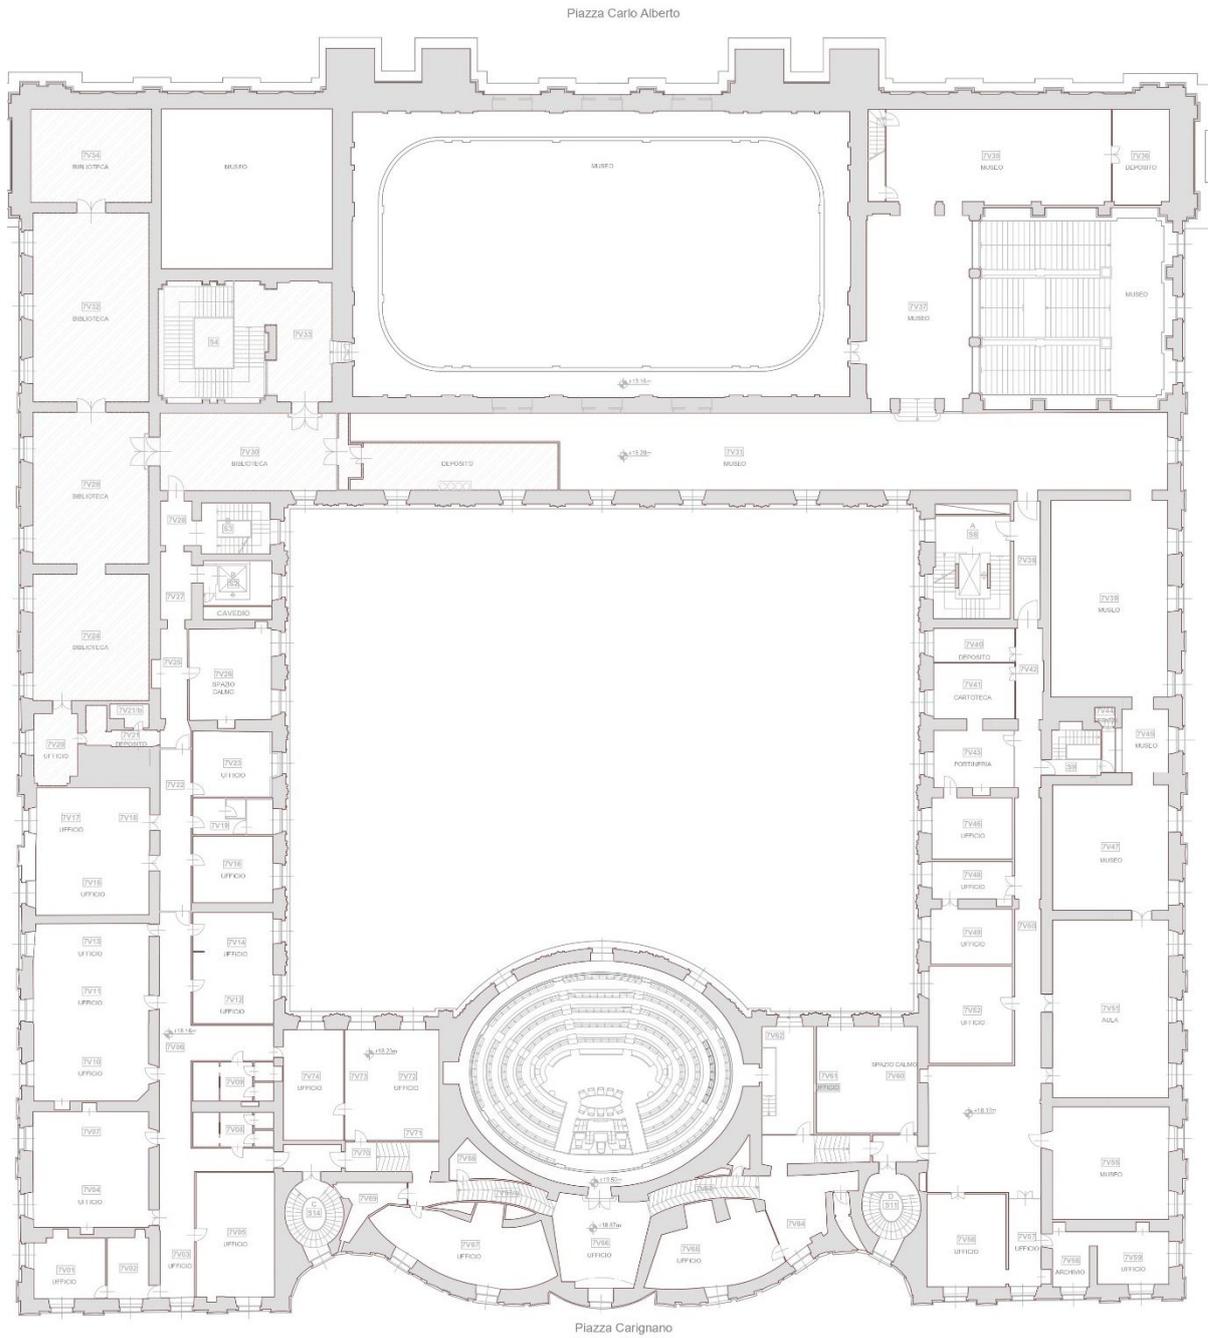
Pianta piano quinto, livello +5 (Fuori scala).
